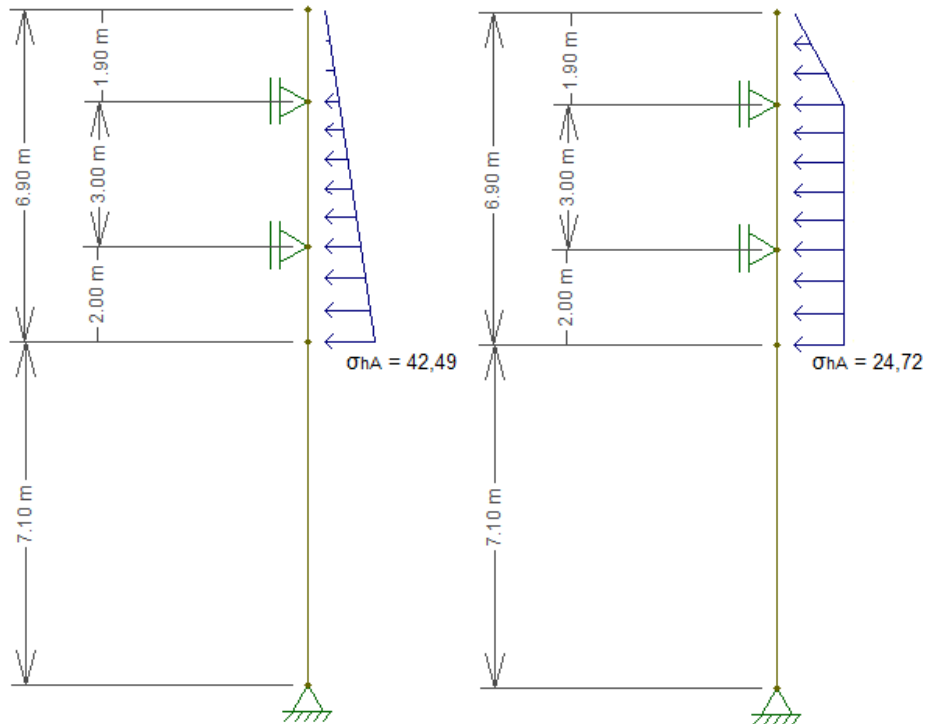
Diagrama de tensões horizontais para a terceira escavação
